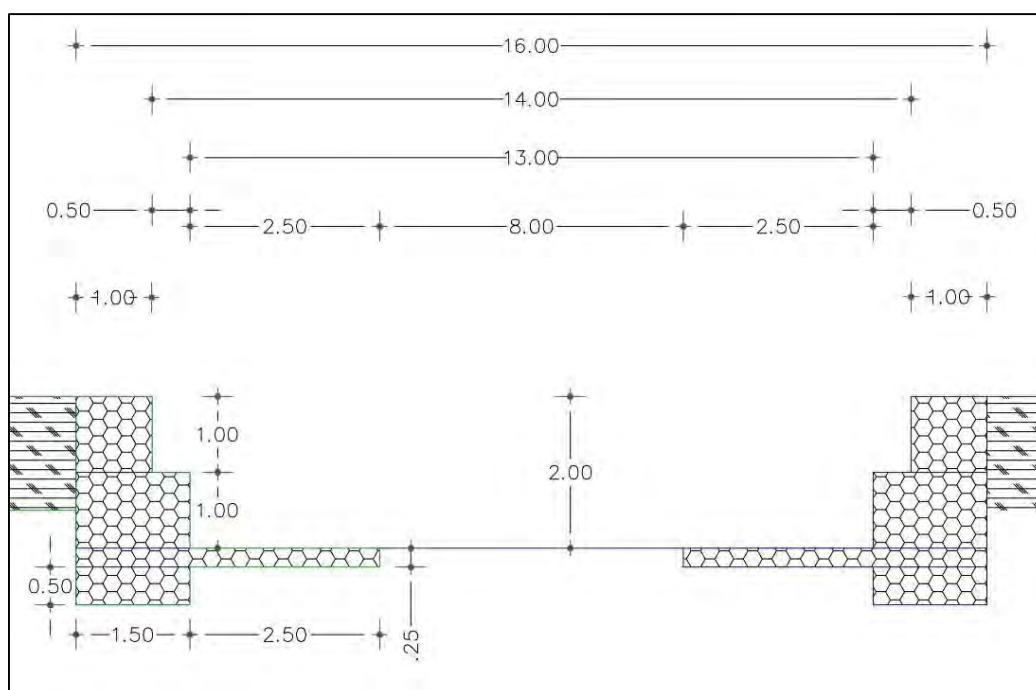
Sezione tipo a valle a del ponte sulla SS 125
